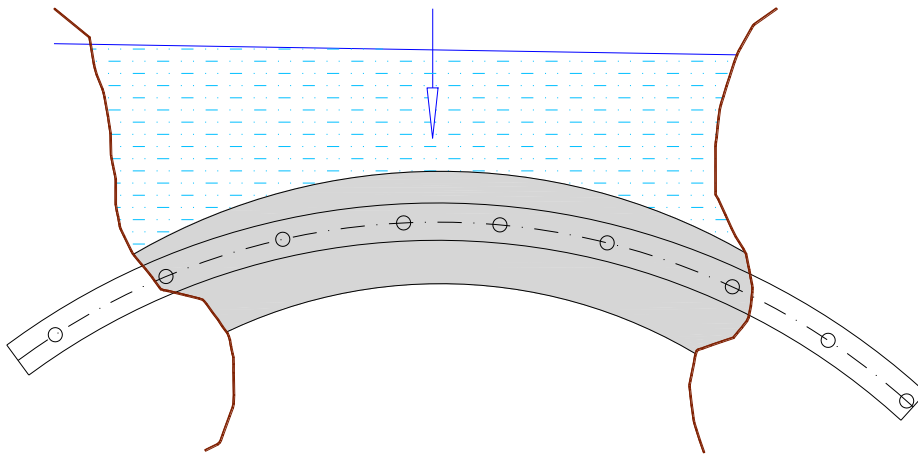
Determinarea deplasărilor horizontale prin metoda drumuirii planimetrice
